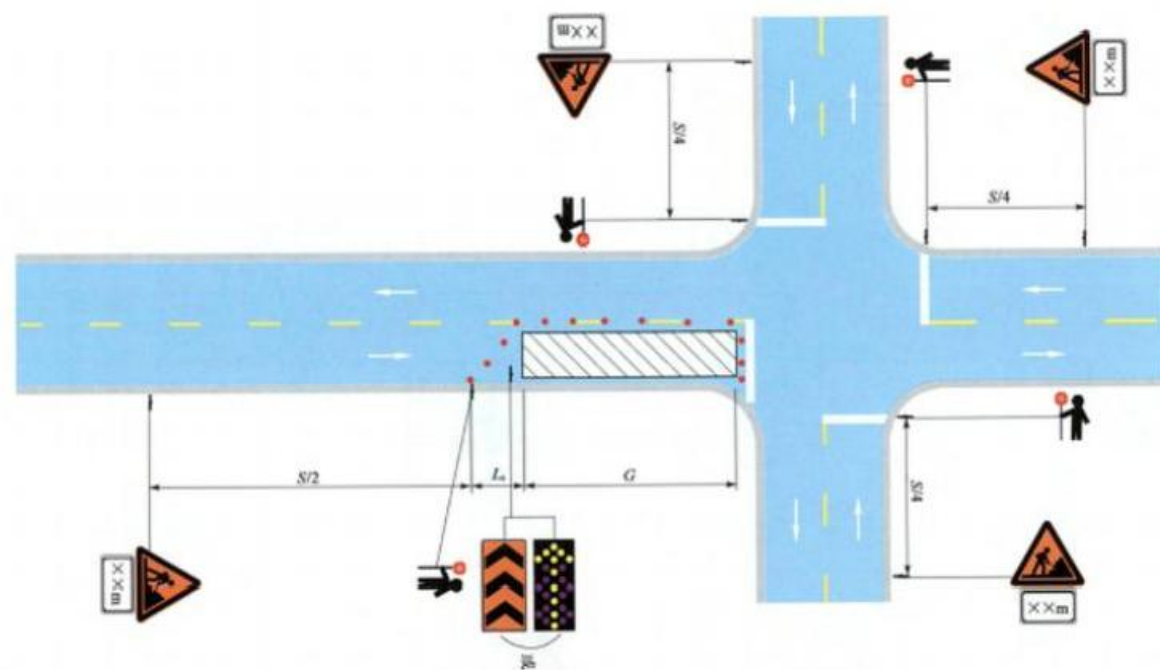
平面交叉路段临时养护作业示意图
